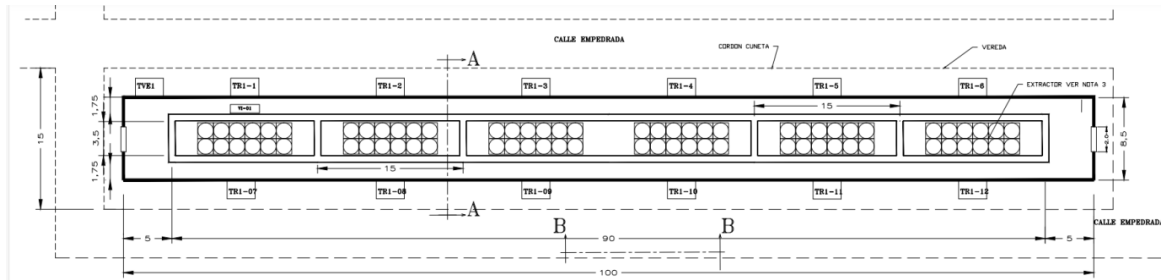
Planta Edificio RM. Alternativa 1: Extractor Horizontal
